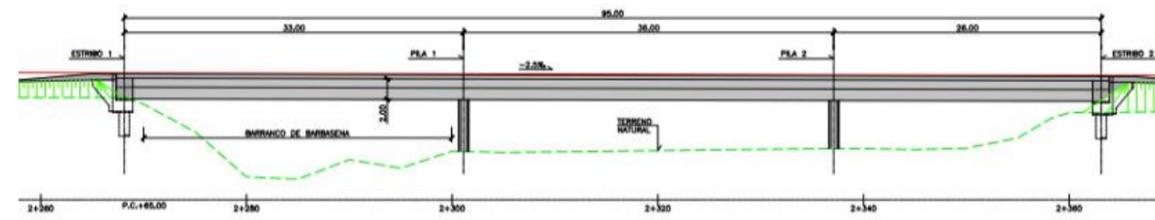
ALZADO VIADUCTO P.K. 2+320
